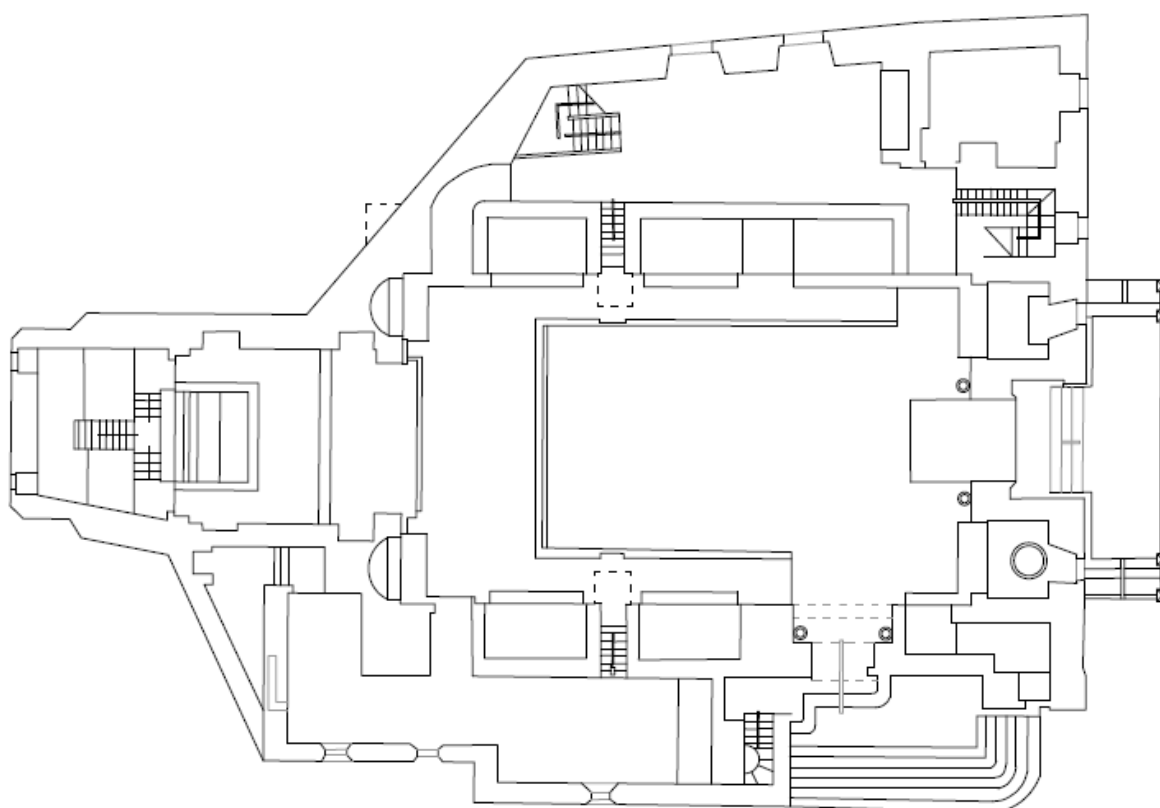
Planta da Igreja de São Cristóvão (sem escala) [55]
